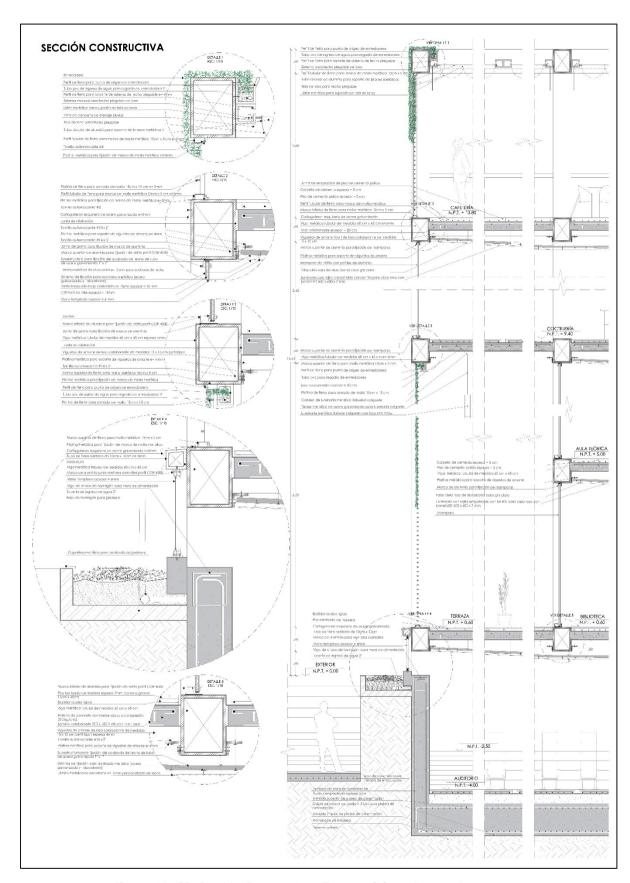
Sección Constructiva Fuente: elaboración propia
